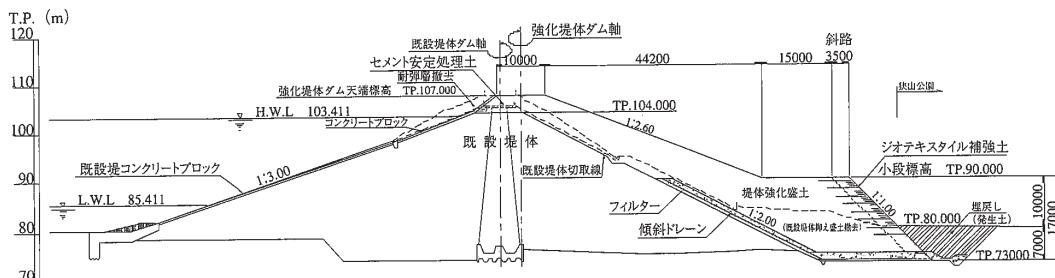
震度法による耐震設計で設定した堤体強化工法基本断面
